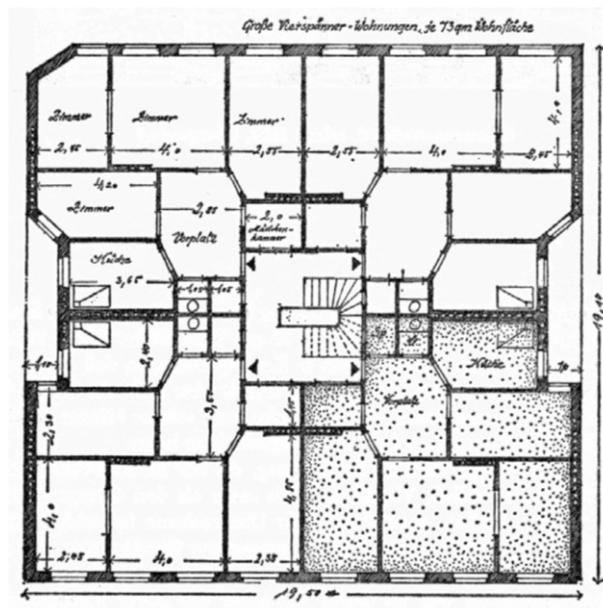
Typischer H-Grundriss[25]
